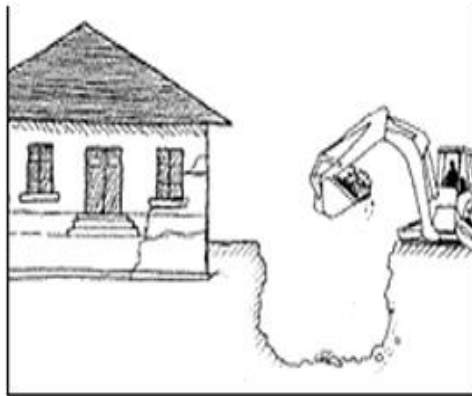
Excavation en limite d'un bâtiment. [1]
